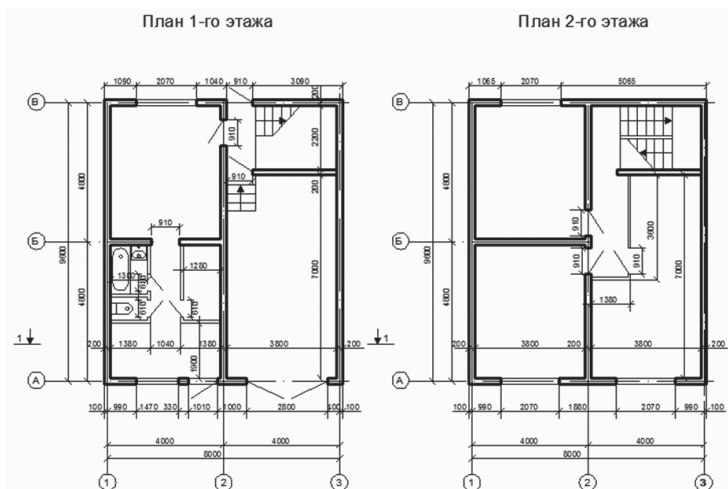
Объемно-планировочные решения малоэтажного блокированного жилого дома
